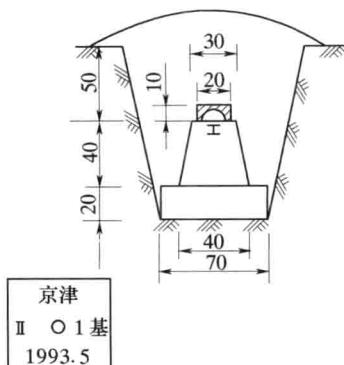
混凝土普通水准标石埋设图 (单位: cm)
